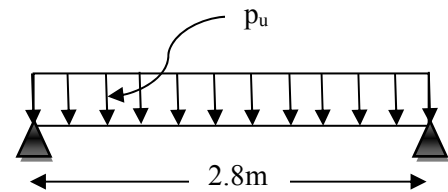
Schéma statique de la poutre palier du 2^{ème} Type d'escalier.
